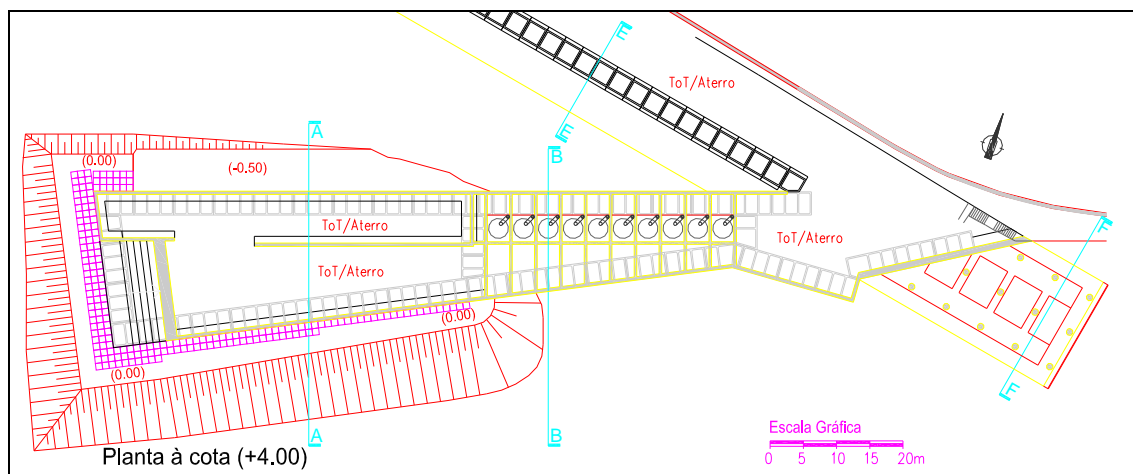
Planta estrutural (ao nível da cota +4,0 m (ZH))
